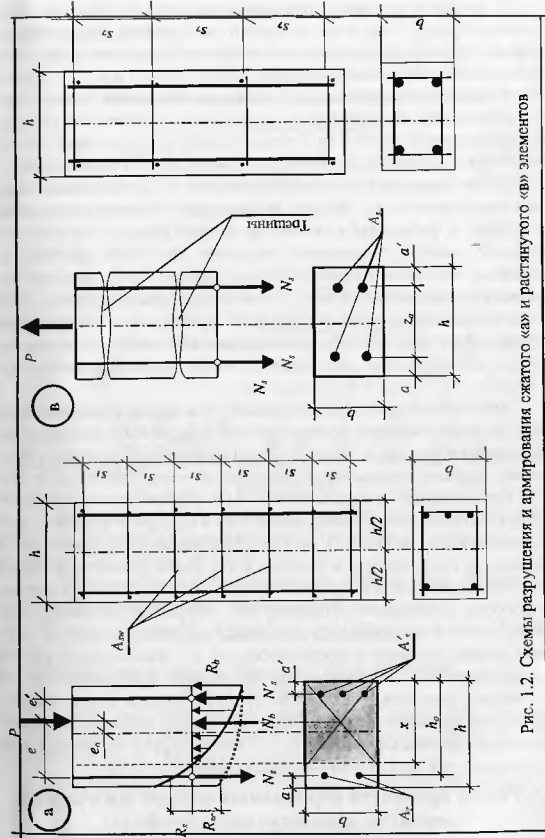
Схема разрушения и армирования скрутого «а» и растянутого «в» элементов
